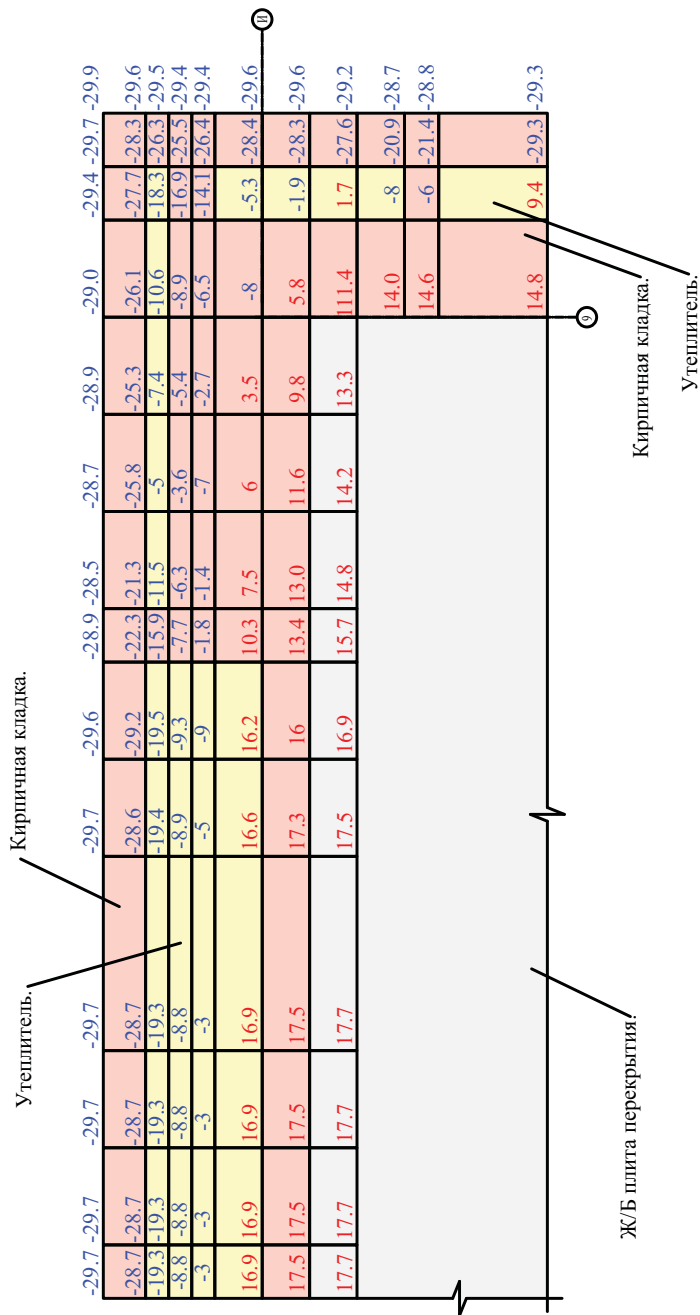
е Узел 1. Температуры в сечении в уровне опирания плит перекрытия (технологический расчет выполнен к.т.н. Котиным М.В.)
